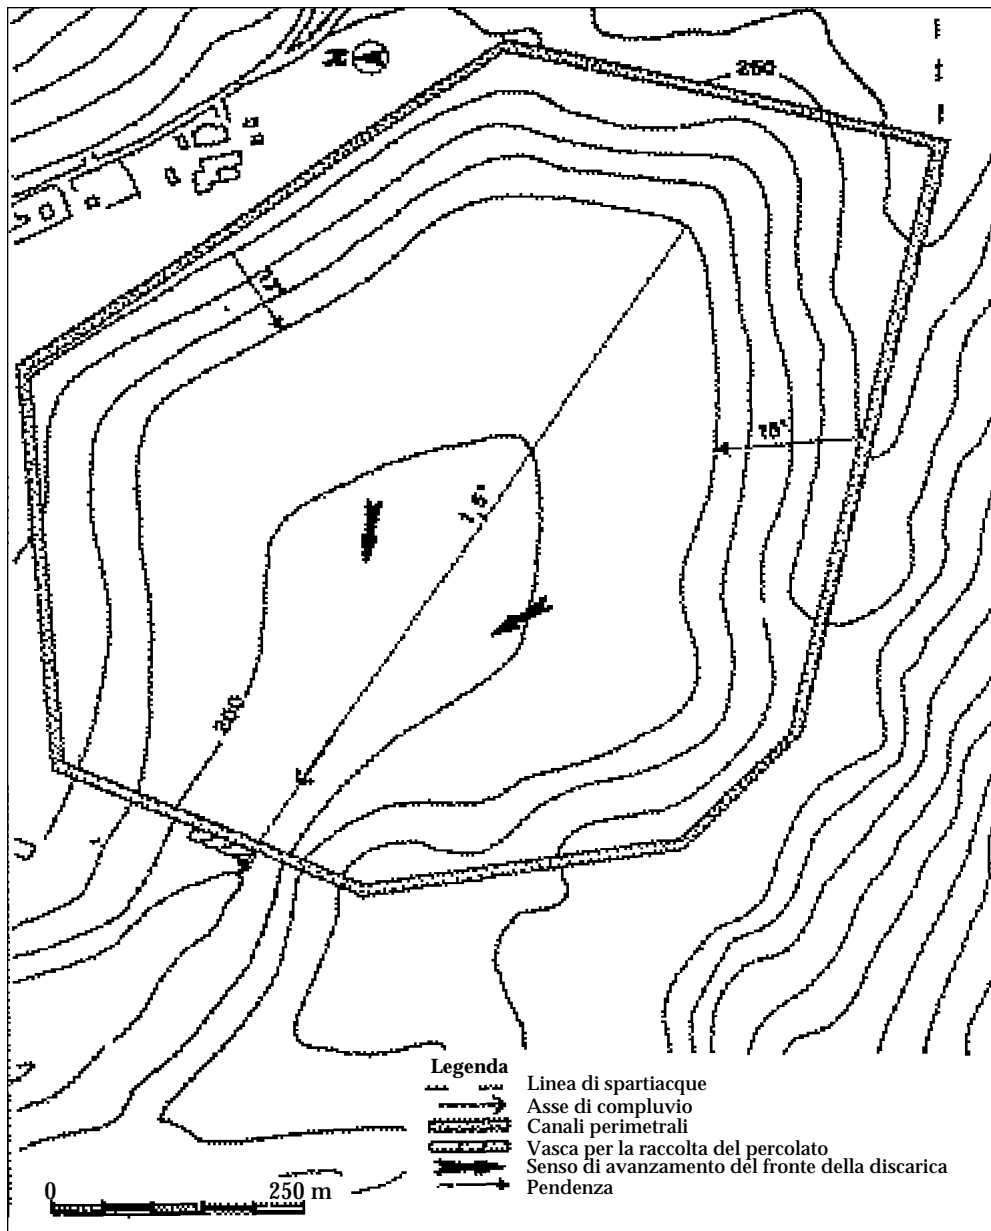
Planimetria relativa alla sistemazione finale dell'impianto.
